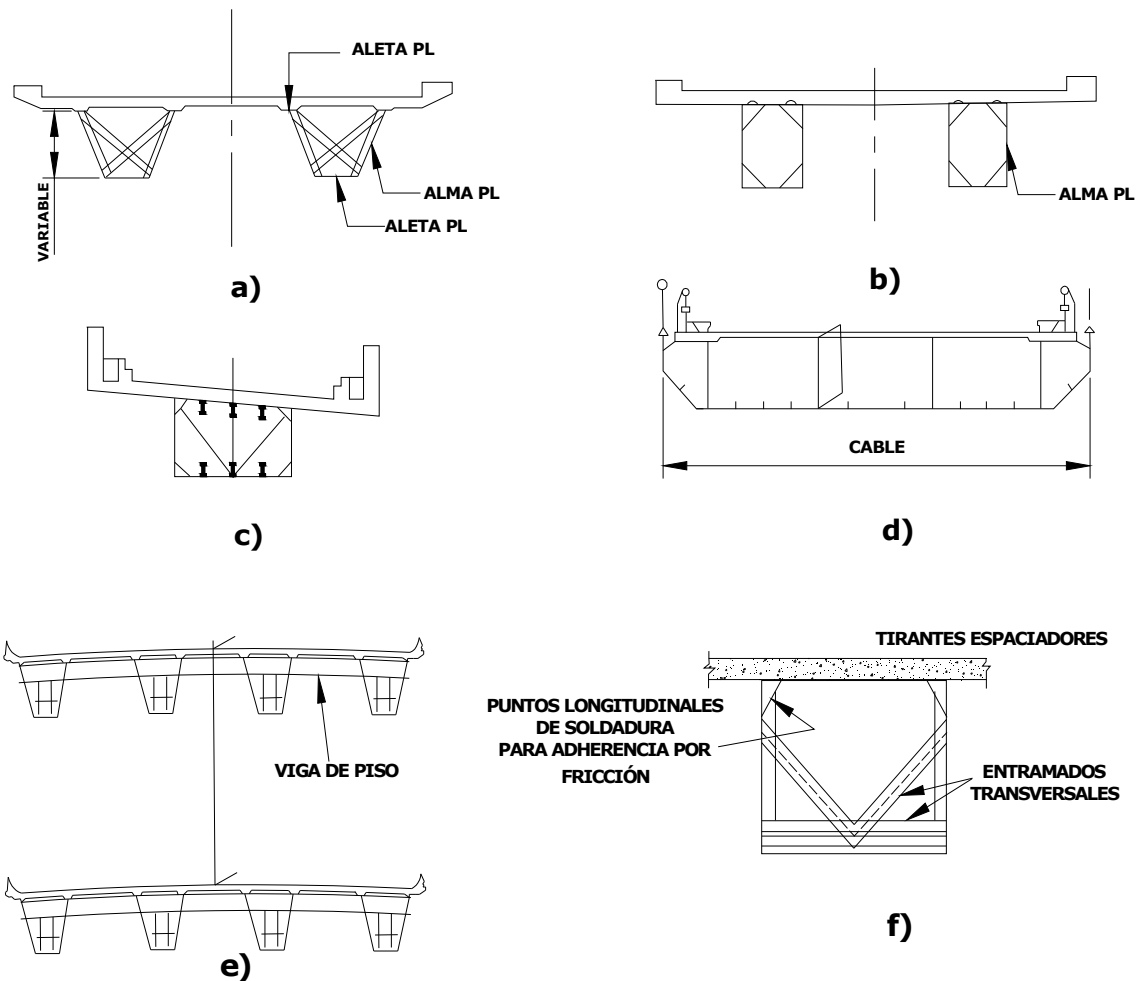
30 Vigas tipo cajón con tablero ortotrópico
